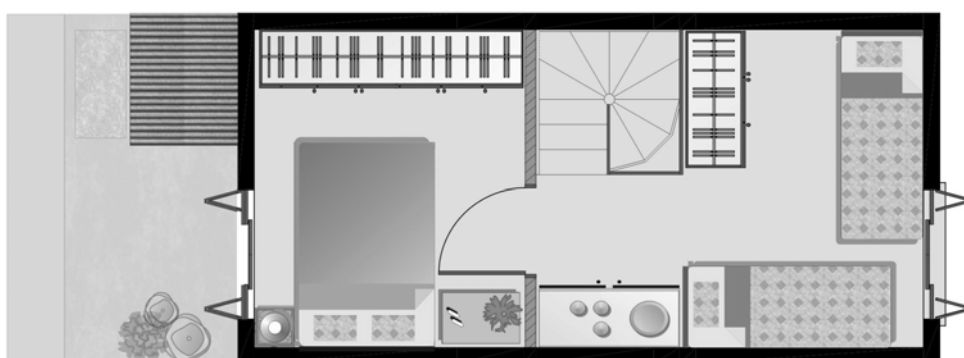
Planta do Segundo Pavimento do Sobrado - UH009
